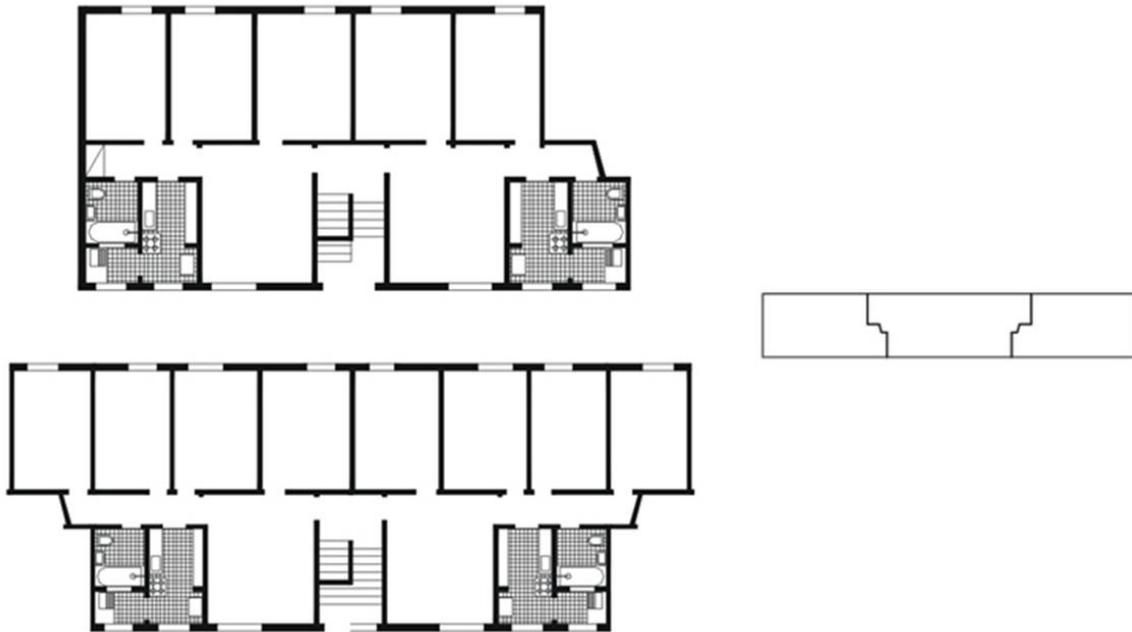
Planta baixa do bloco de apartamentos do Residencial Várzea do Carmo – 2 e 3 dormitórios.
